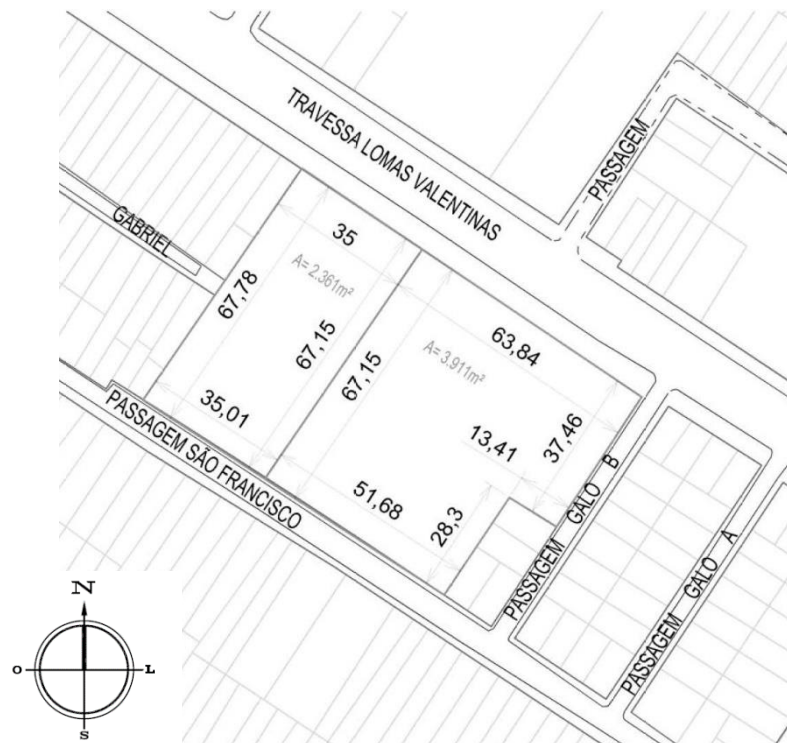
Planta do terreno indicando a divisão de lotes pretendida na área. Fonte: Adaptado do CTM de Belém.
